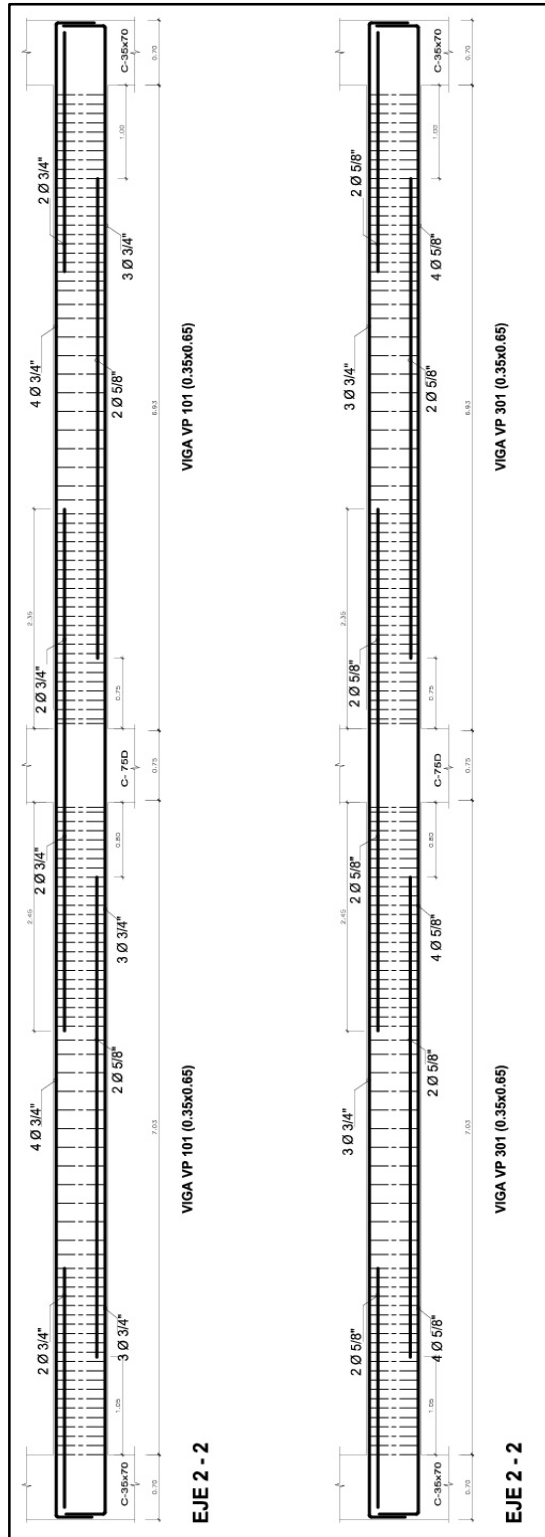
Acero longitudinal en vigas del eje 2-2 del primer y tercer nivel.
